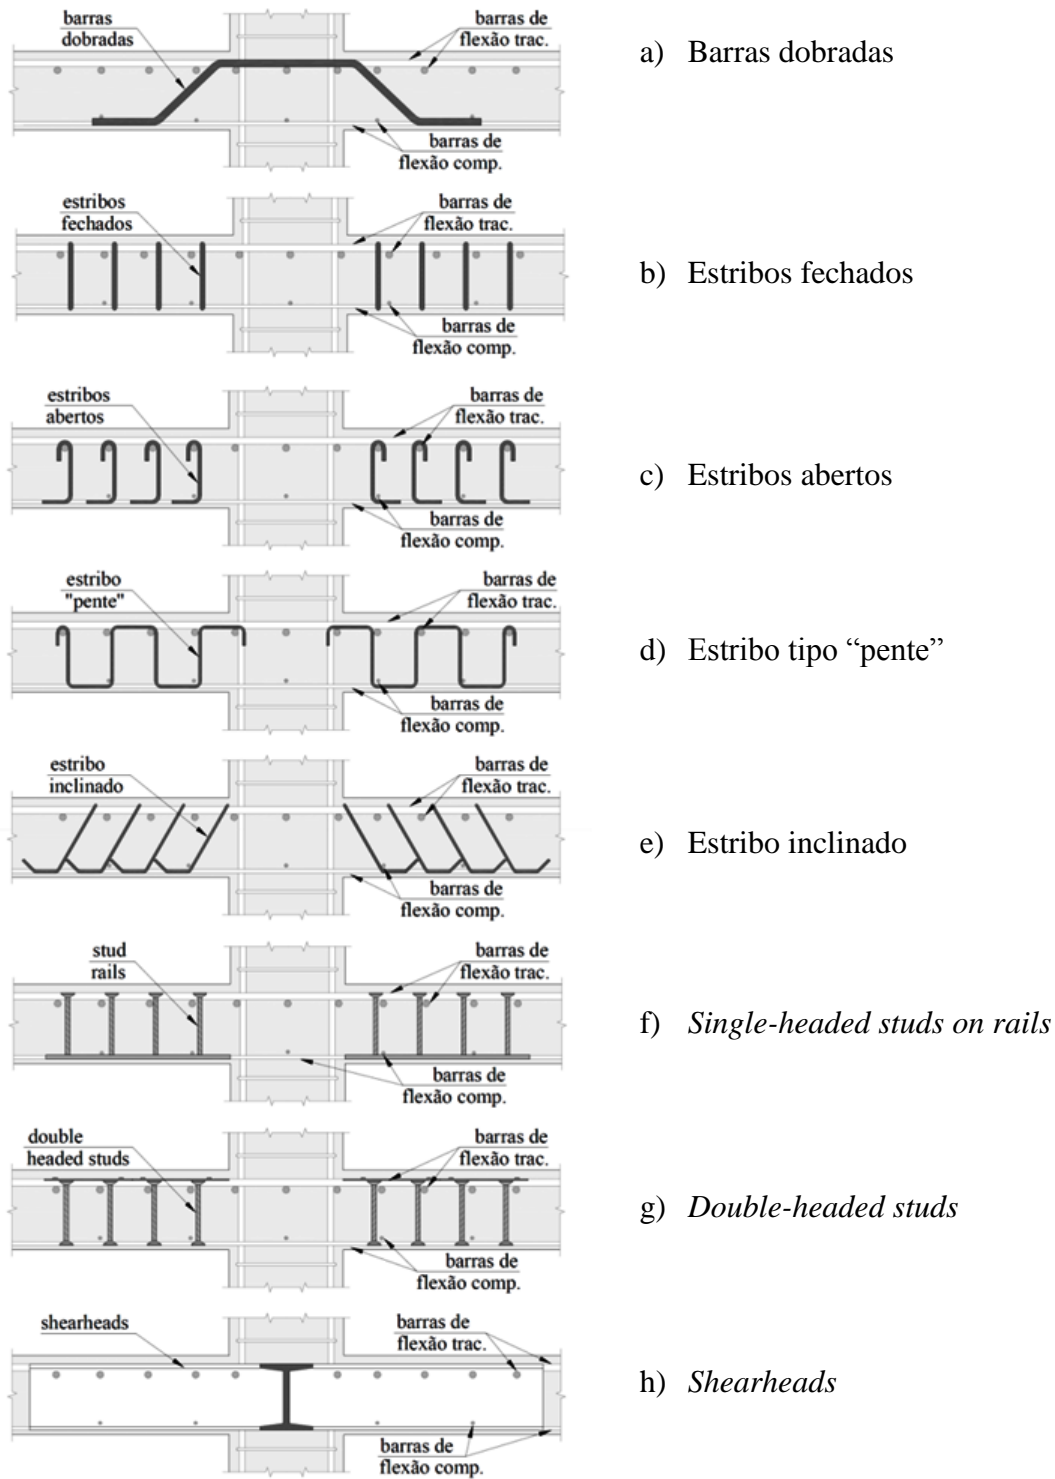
Tipos de armaduras de cisalhamento para lajes lisas. [FERREIRA (2010)]
